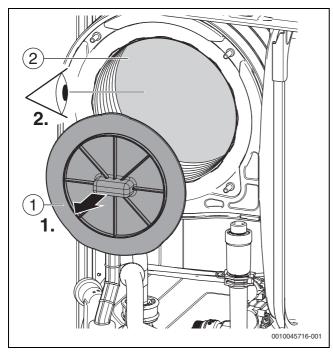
Rimuovere la protezione dell'isolamento e controllare l'isolamento
